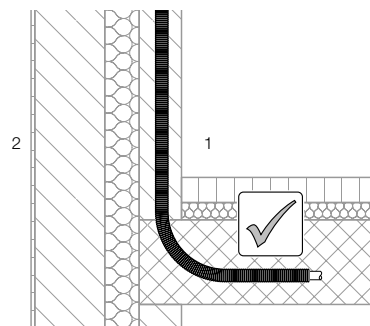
Leiding lay-out door uitsparing in het plafond
